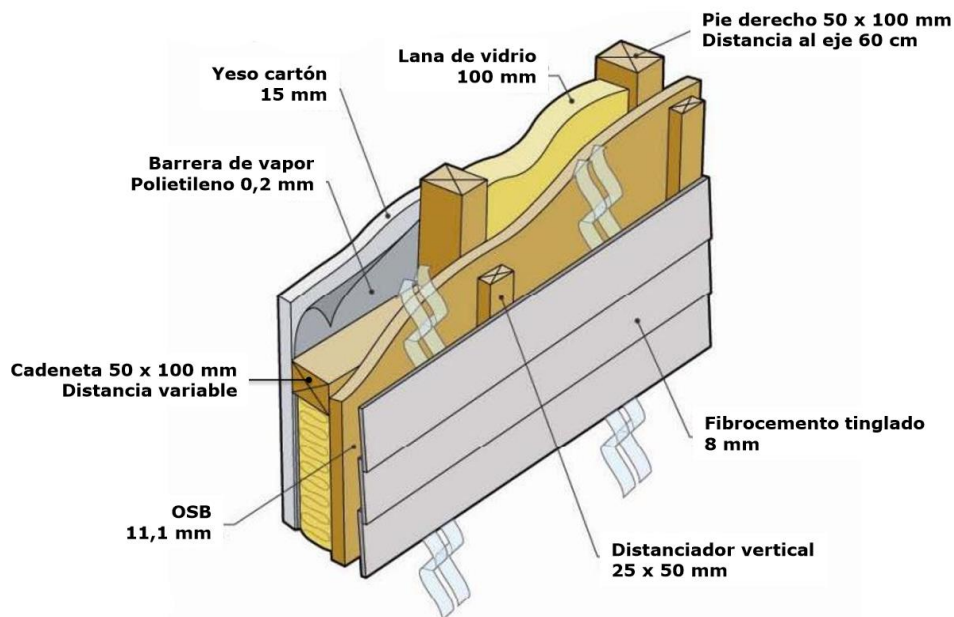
Muro exterior tipo tabique de madera con fachada ventilada (C.Perez)
